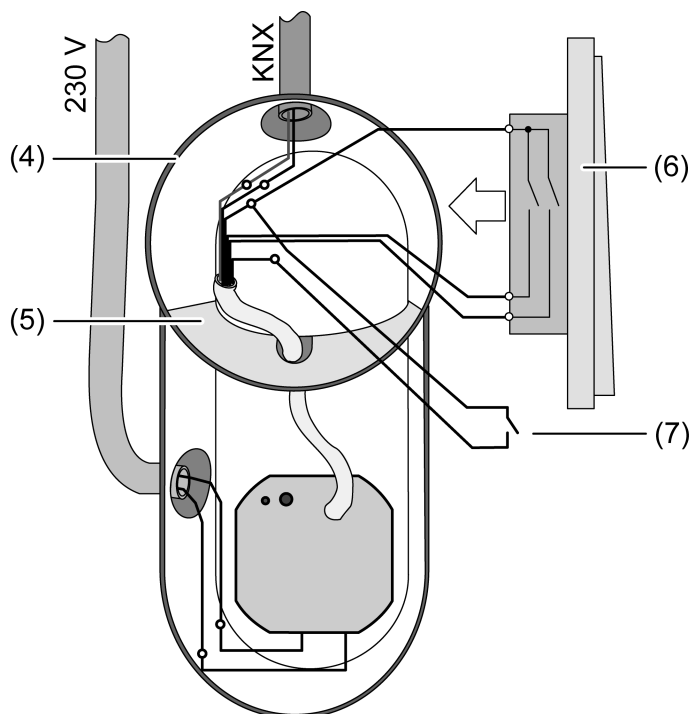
Montaje del aparato en una caja electrónica (ejemplo)
